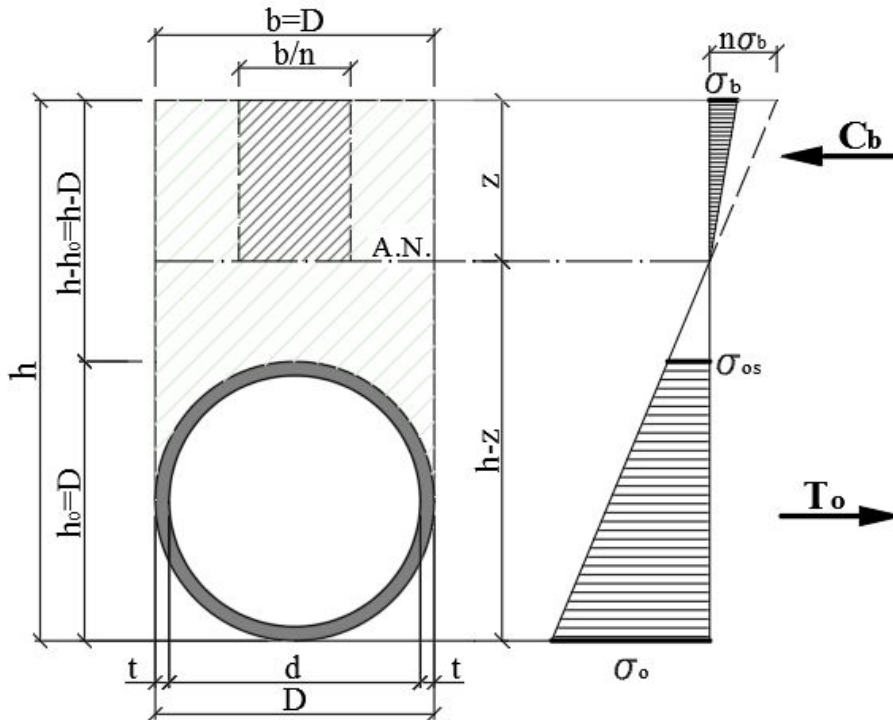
1. Model de calcul pentru structură mixtă oțel-beton cu structura metalică din țevi de oțel tangențiale
